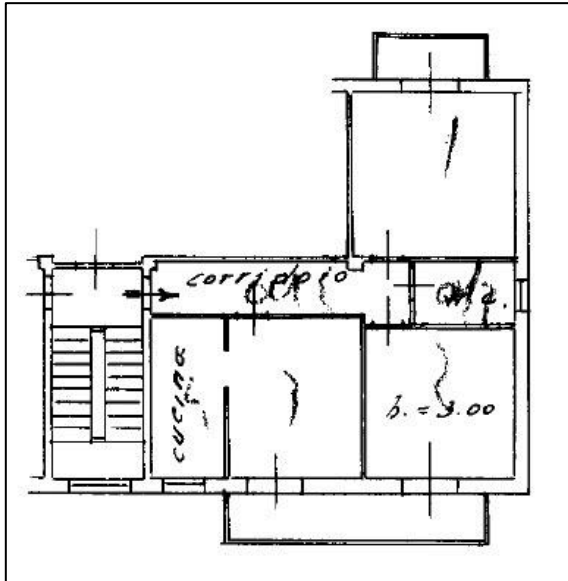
Planimetria catastale del 31.12.1964- Appartamento
